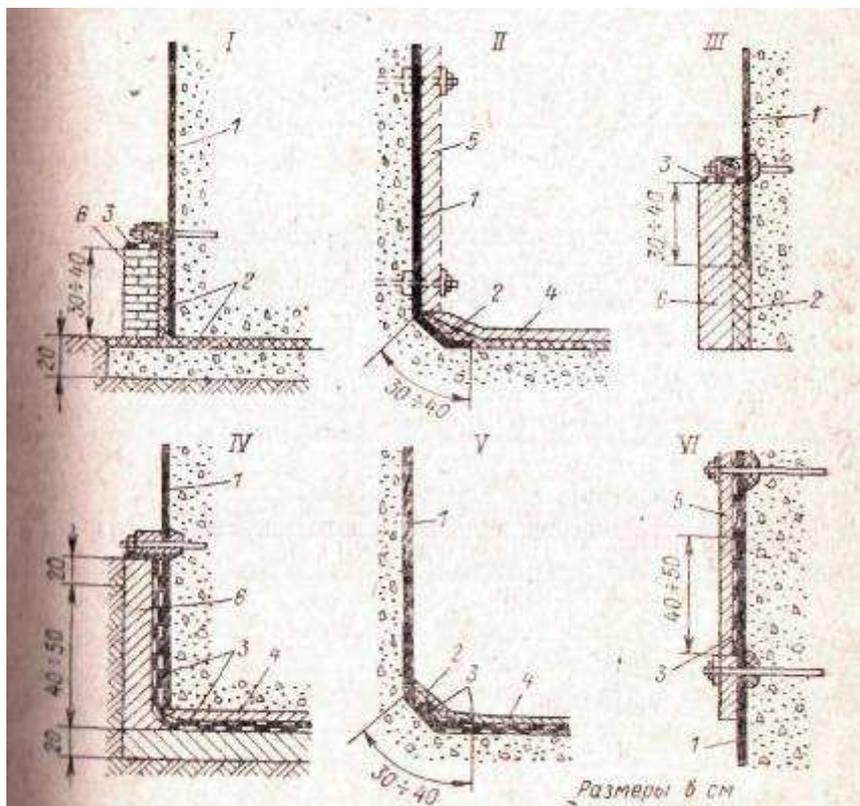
Устройство сопряжений штукатурной, гидроизоляции с гидроизоляциями других видов (к п. 2.26)
